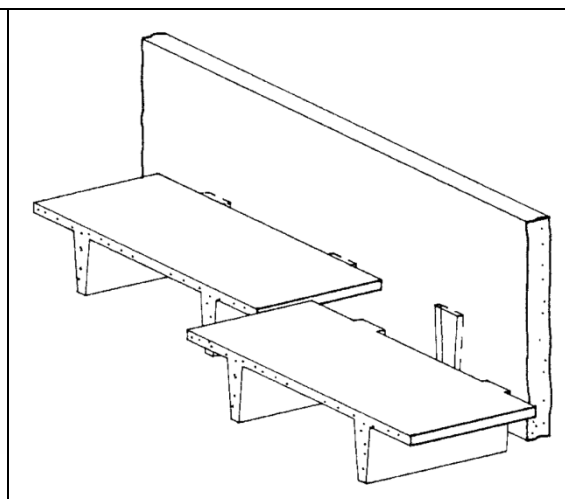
Ligação de lajes duplo “T” apoiadas no encaixe na viga-parede, perpendiculares à laje de piso (PCI)
